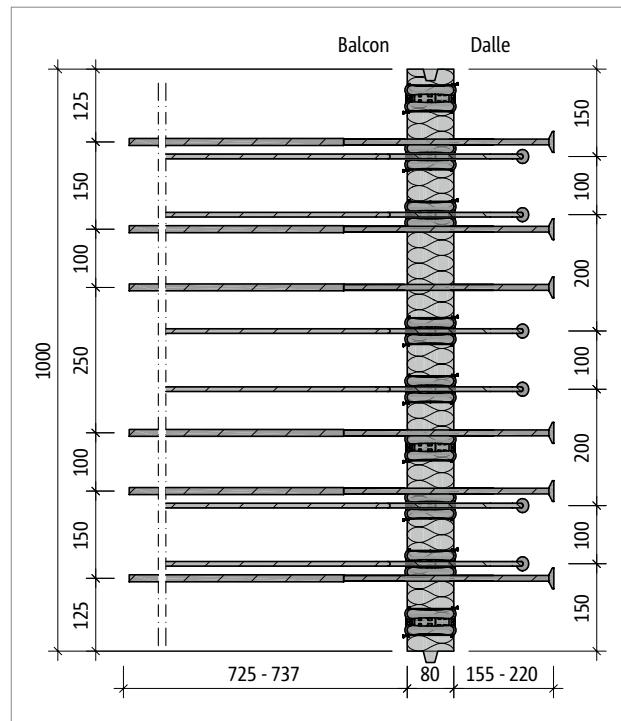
Schöck Isokorb® T type K-U-M2 : plan de base du produit
